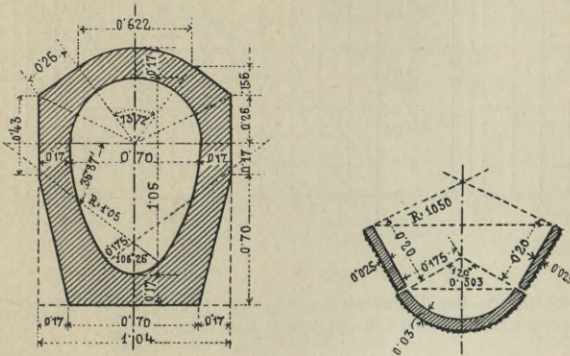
Eikanal aus Stampfbeton mit Steinzeugschalen.
